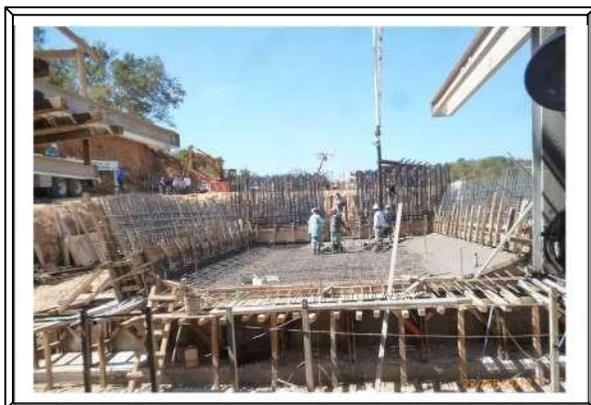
Colado de la Losa de fondo, dovela de orilla E-4.
